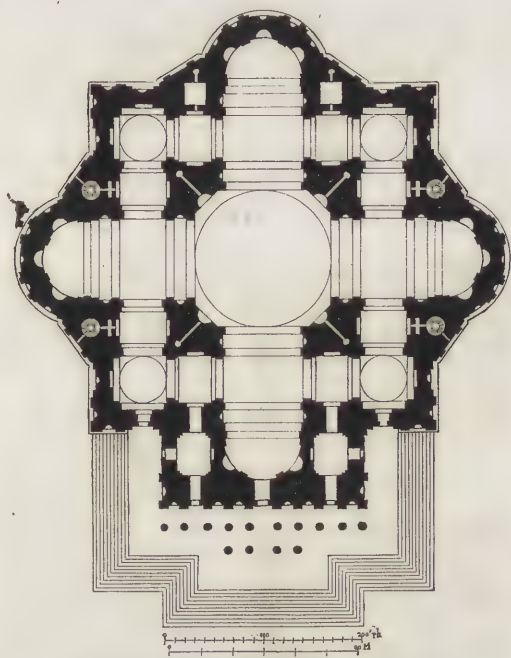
S. Peter. Michelangelo's Grundriss.
